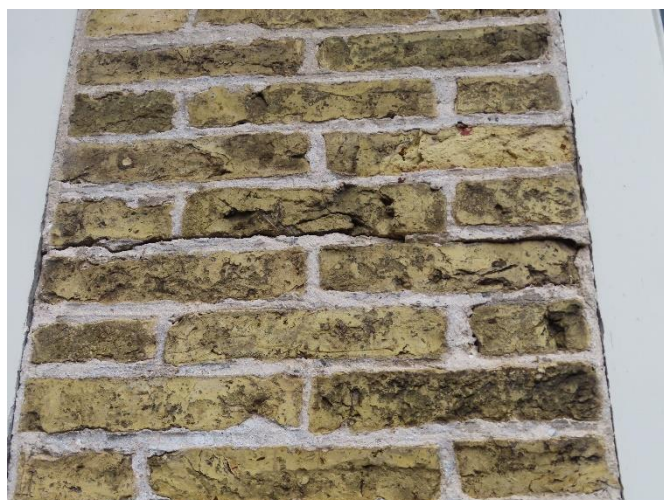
; horizontale scheurvorming in metselwerk beer tussen vensters.
